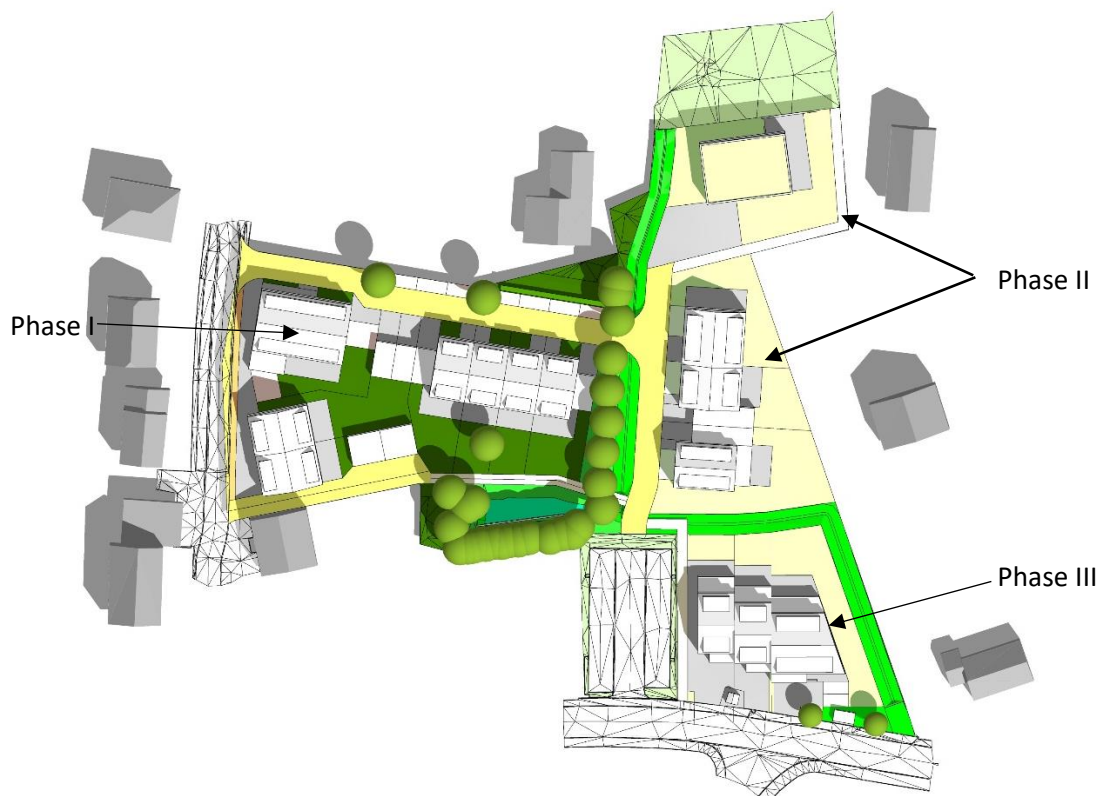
PAP « Am Päsch » plan d'ensemble (source : BEST)
